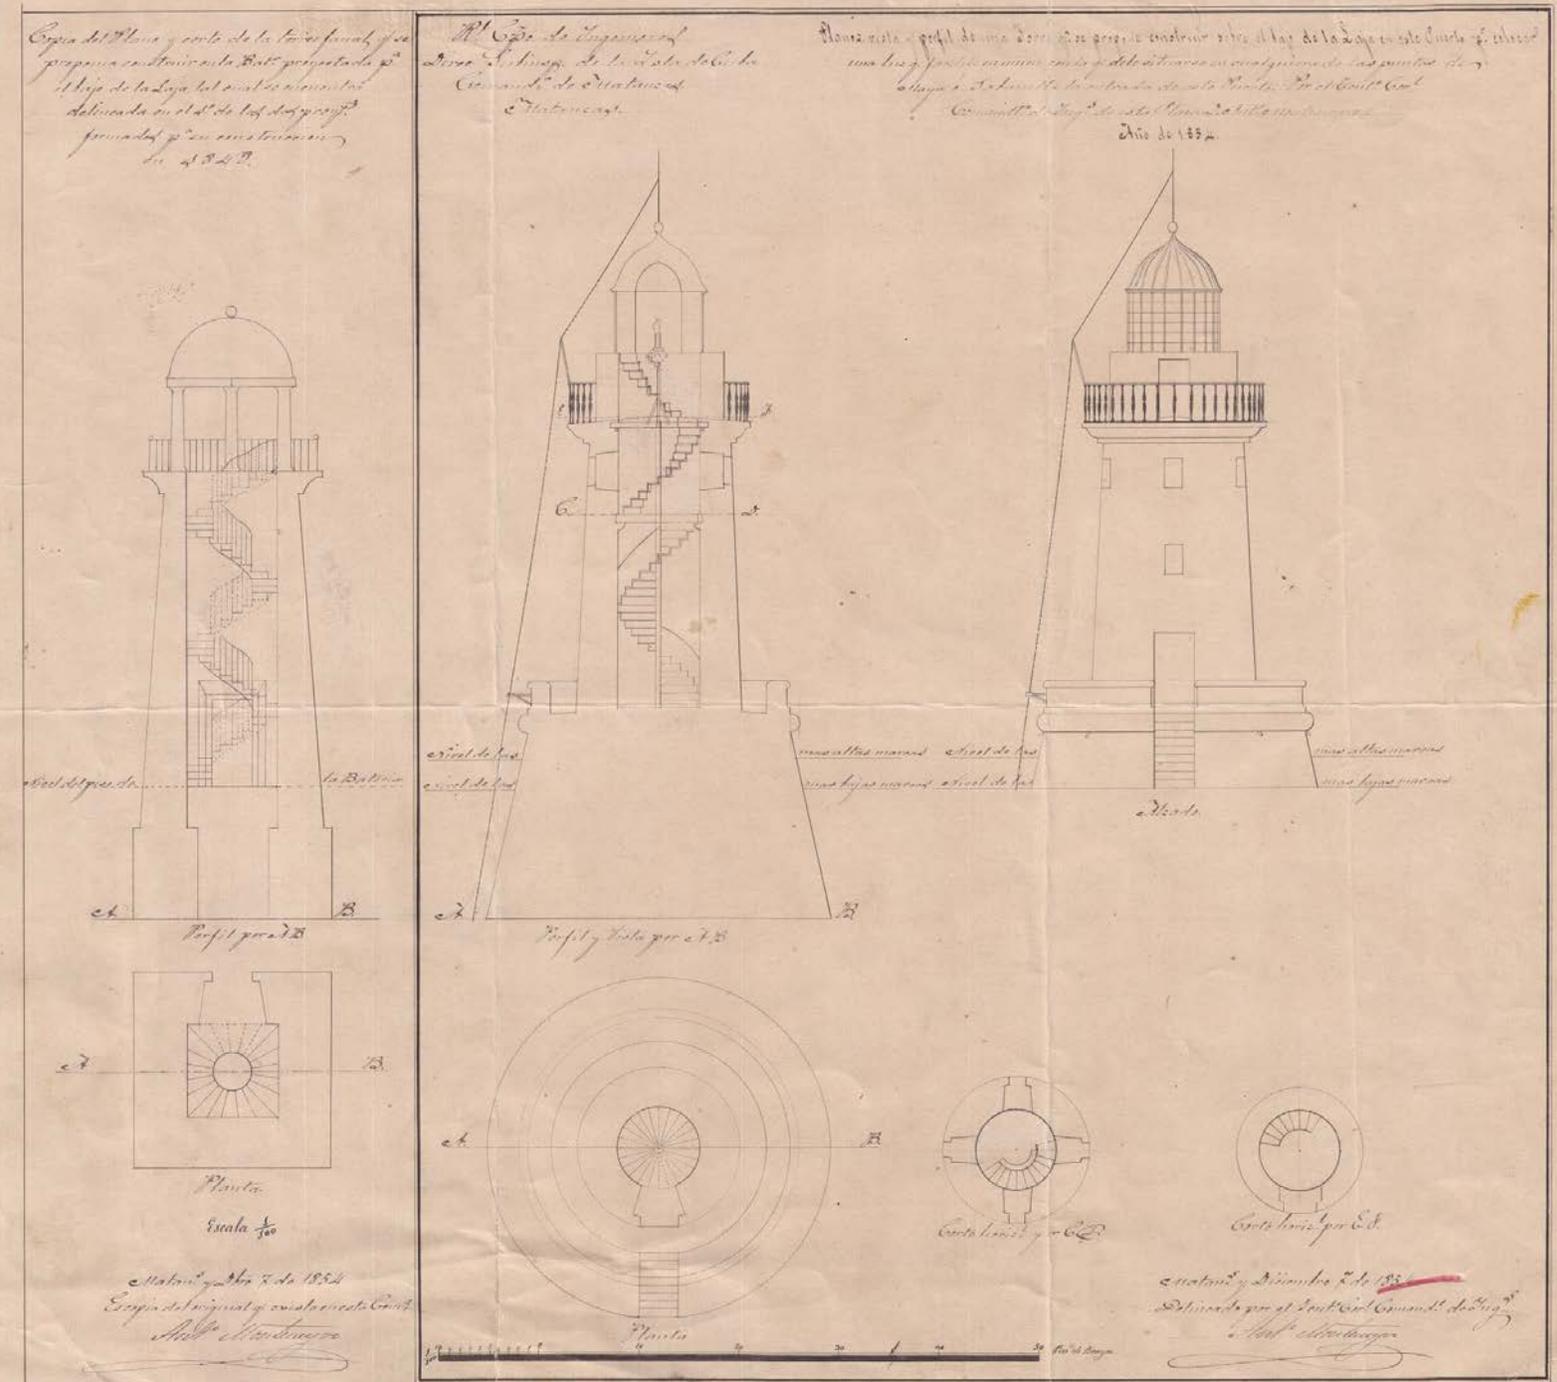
Planos, vista y perfil de una torre (faro) que se propone construir sobre el bajo de la Laja en este puerto para colocar una luz que facilite en unión con la que debe situarse en cualquiera de las puntas de Maya ó Sabanilla la entrada de este puerto. Copia del plano y corte de la torre fanal que se proponía construir en la batería proyectada para el bajo de la Laja, tal cual se encuentra delineada en el 1º de los dos proyectos formados para su construcción en 1848 (1854). AGMM, CUB-60-16.
